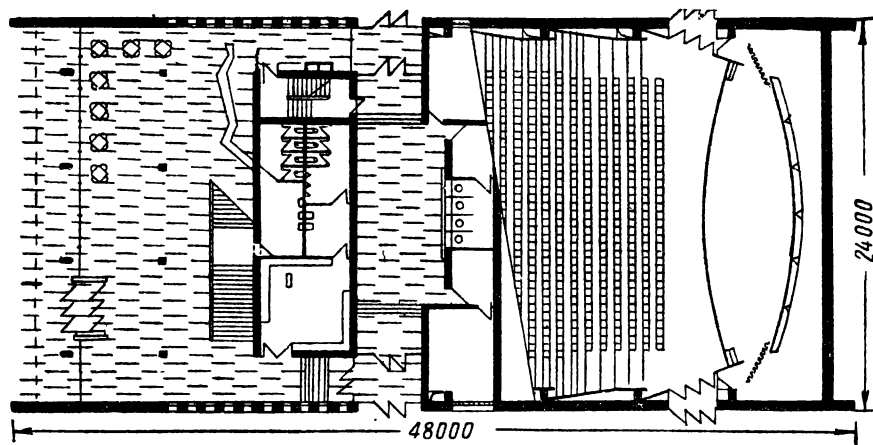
План первого этажа кинотеатра на 800 мест из полносборных конструкций
